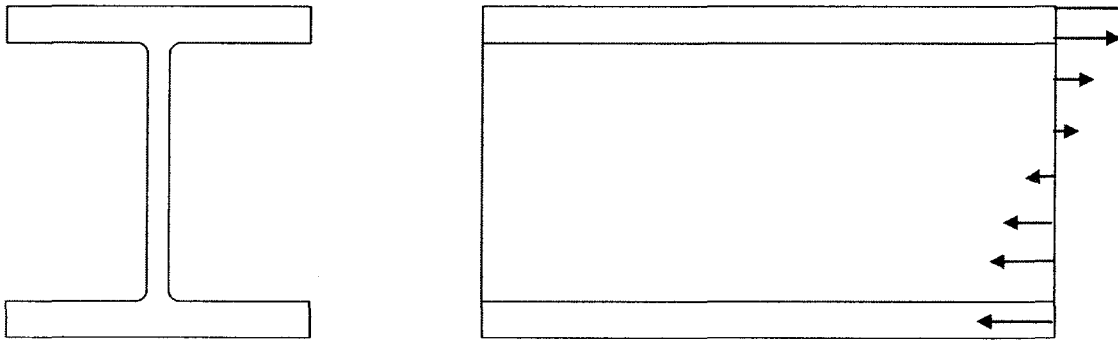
Plano de distribución de esfuerzos de tensión en la viga pluma
